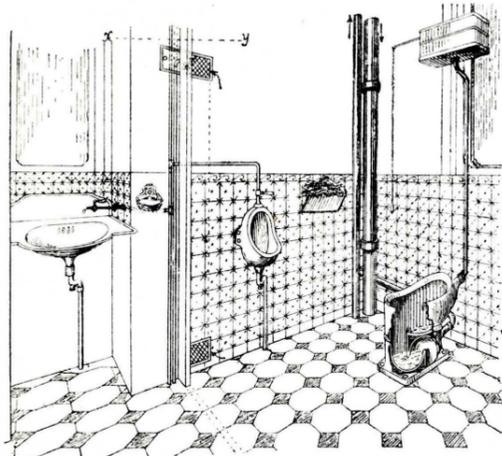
Fig. J. — Latrina e lavabo del piano terreno e piano superiore (vista prospettica).
